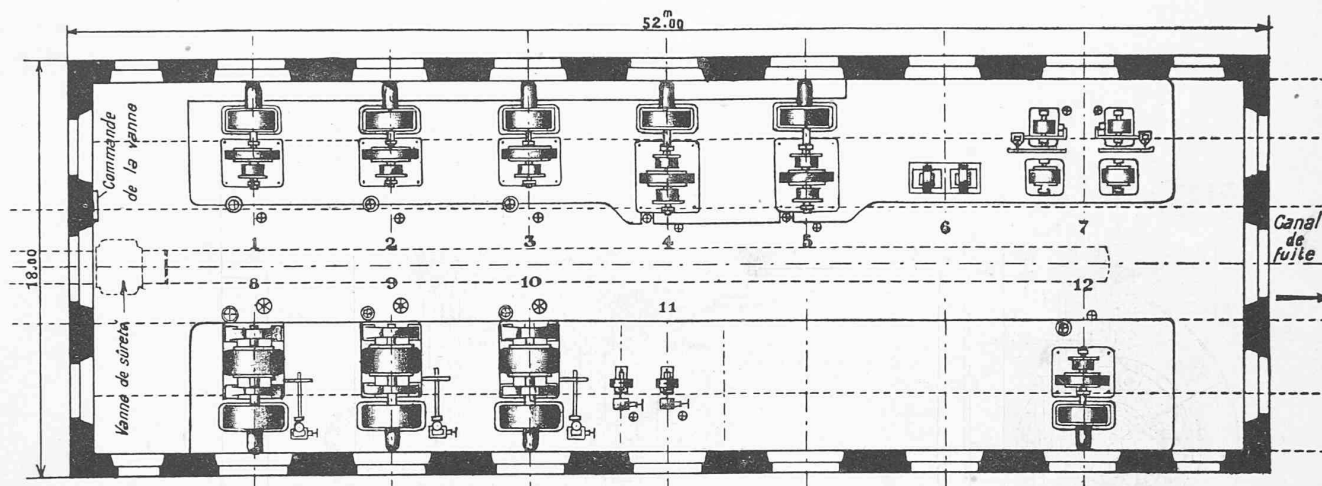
Plan de la salle des machines. — Echelle 1 : 300.
